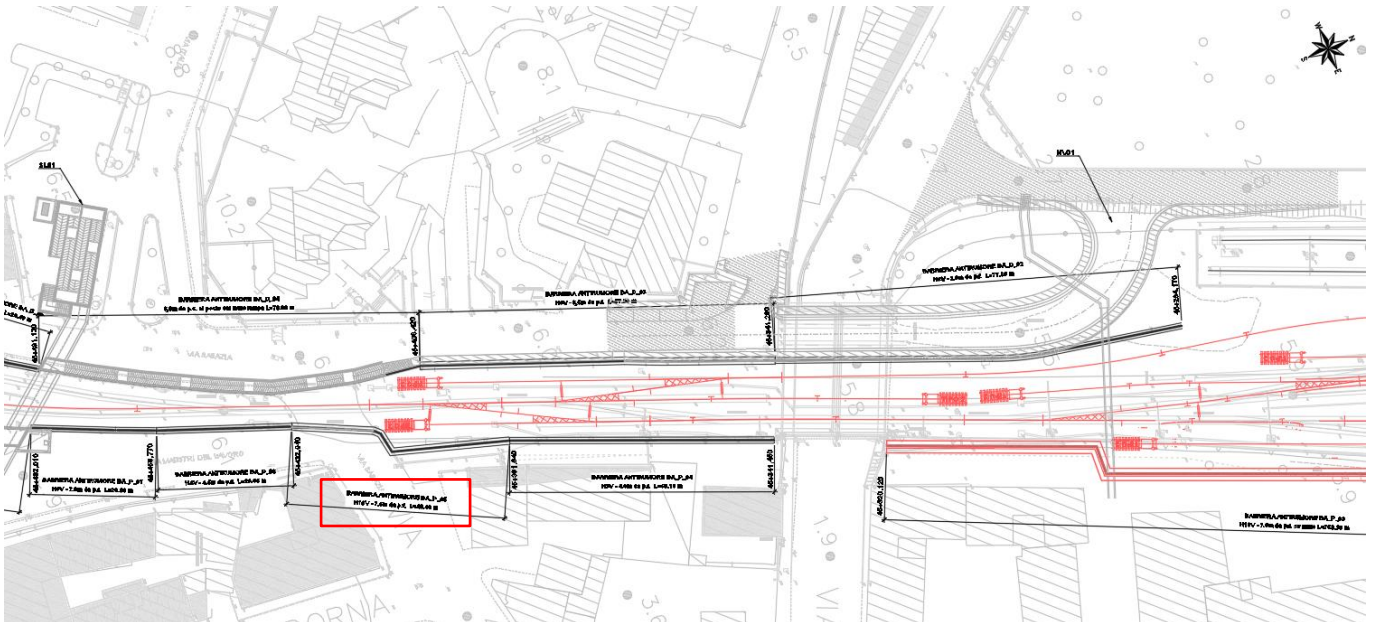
Planimetria di progetto – Barriere H8-H10 – 2 / 2
